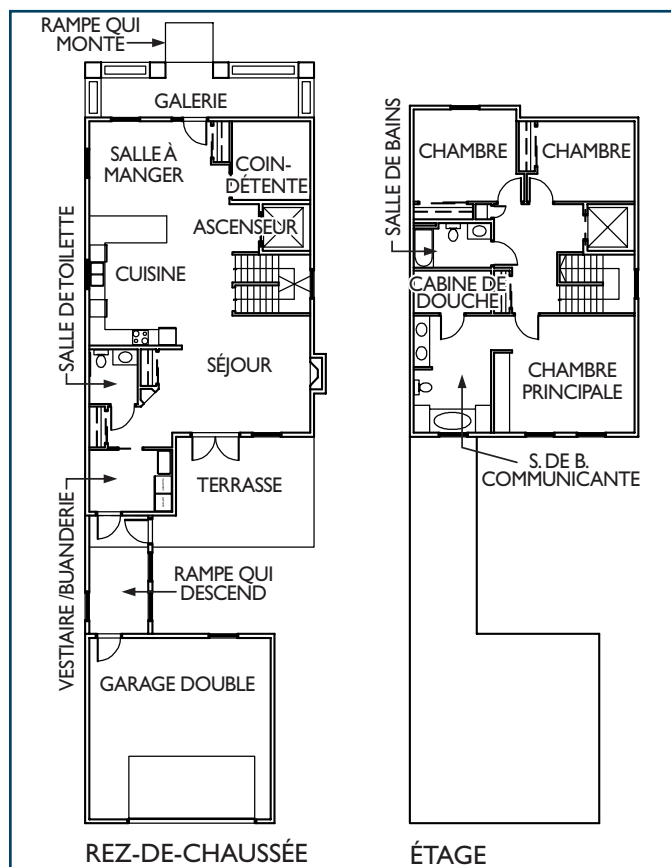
Plans du rez-de-chaussée et de l'étage d'une habitation universelle
